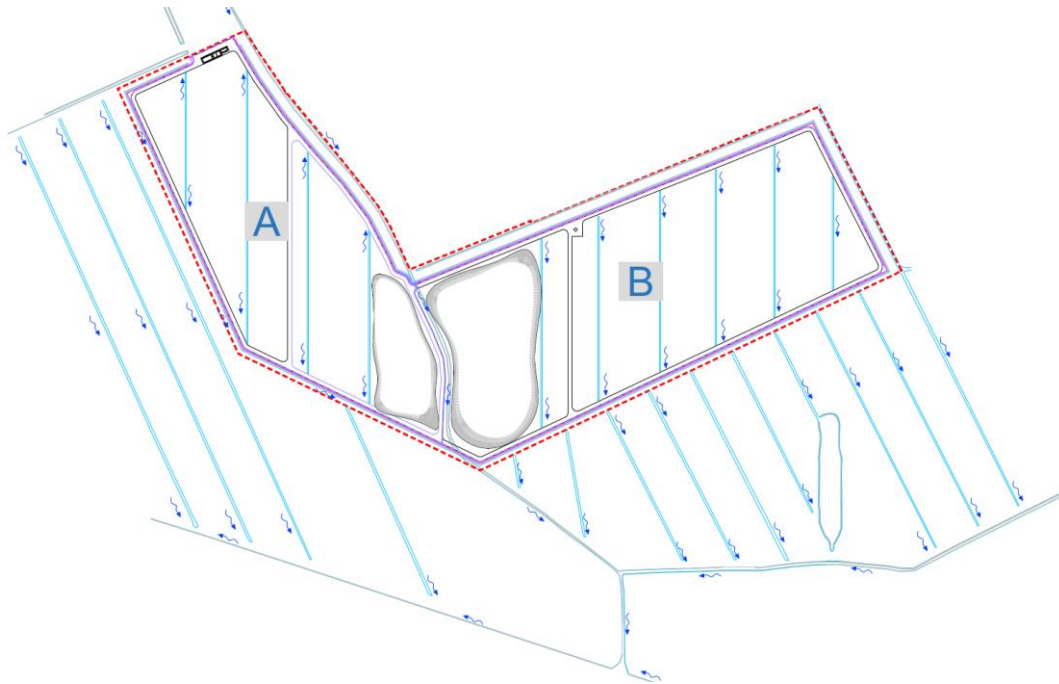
LAY OUT NUOVA DISPOSIZIONE DELLE SCOLINE E FOSSO DI GUARDIA PERIMETRALE
